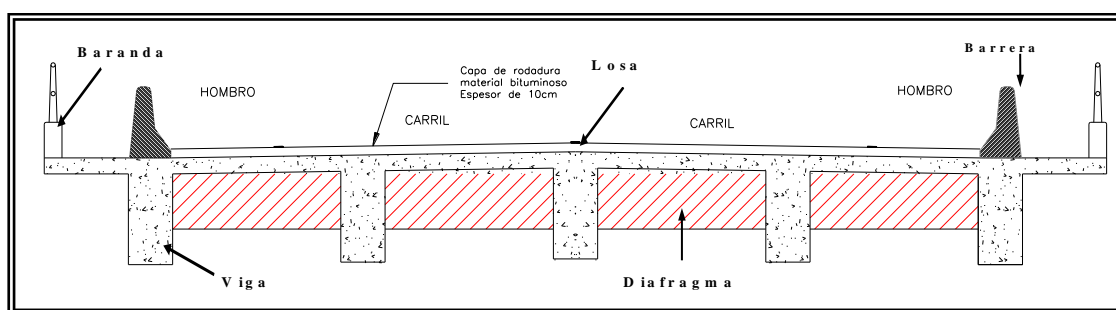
Sección transversal de la propuesta del sistema Viga-Losa.
